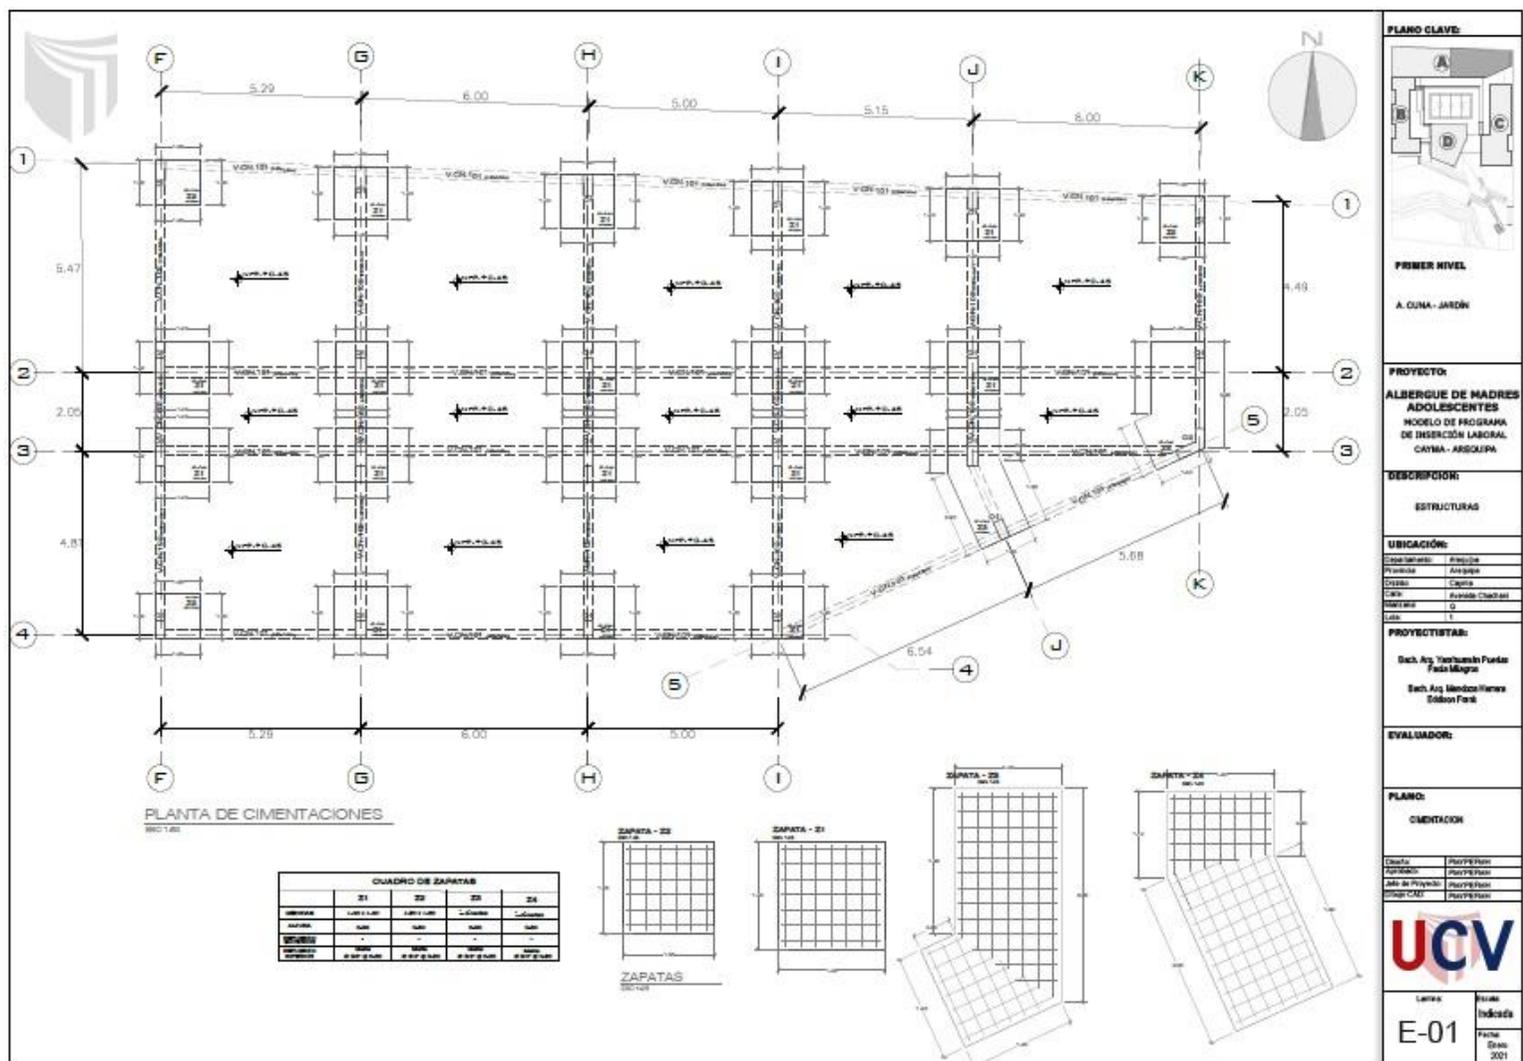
Plano de Cimentación – Sector A – Cuna Jardín E-01.
